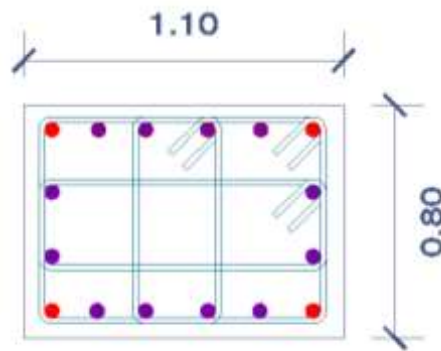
Fierros y estribos en una sección típica del pedestal de concreto
